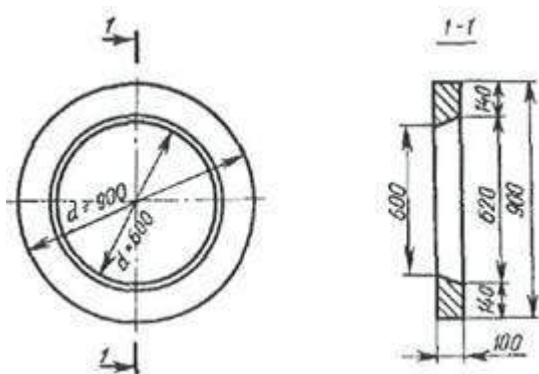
Опорное железобетонное кольцо под люк колодца
